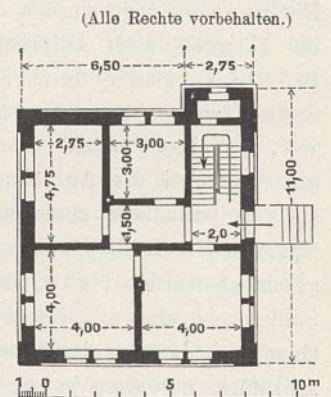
Dienstwohngebäude für den Maschinenmeister. Grundriß.
